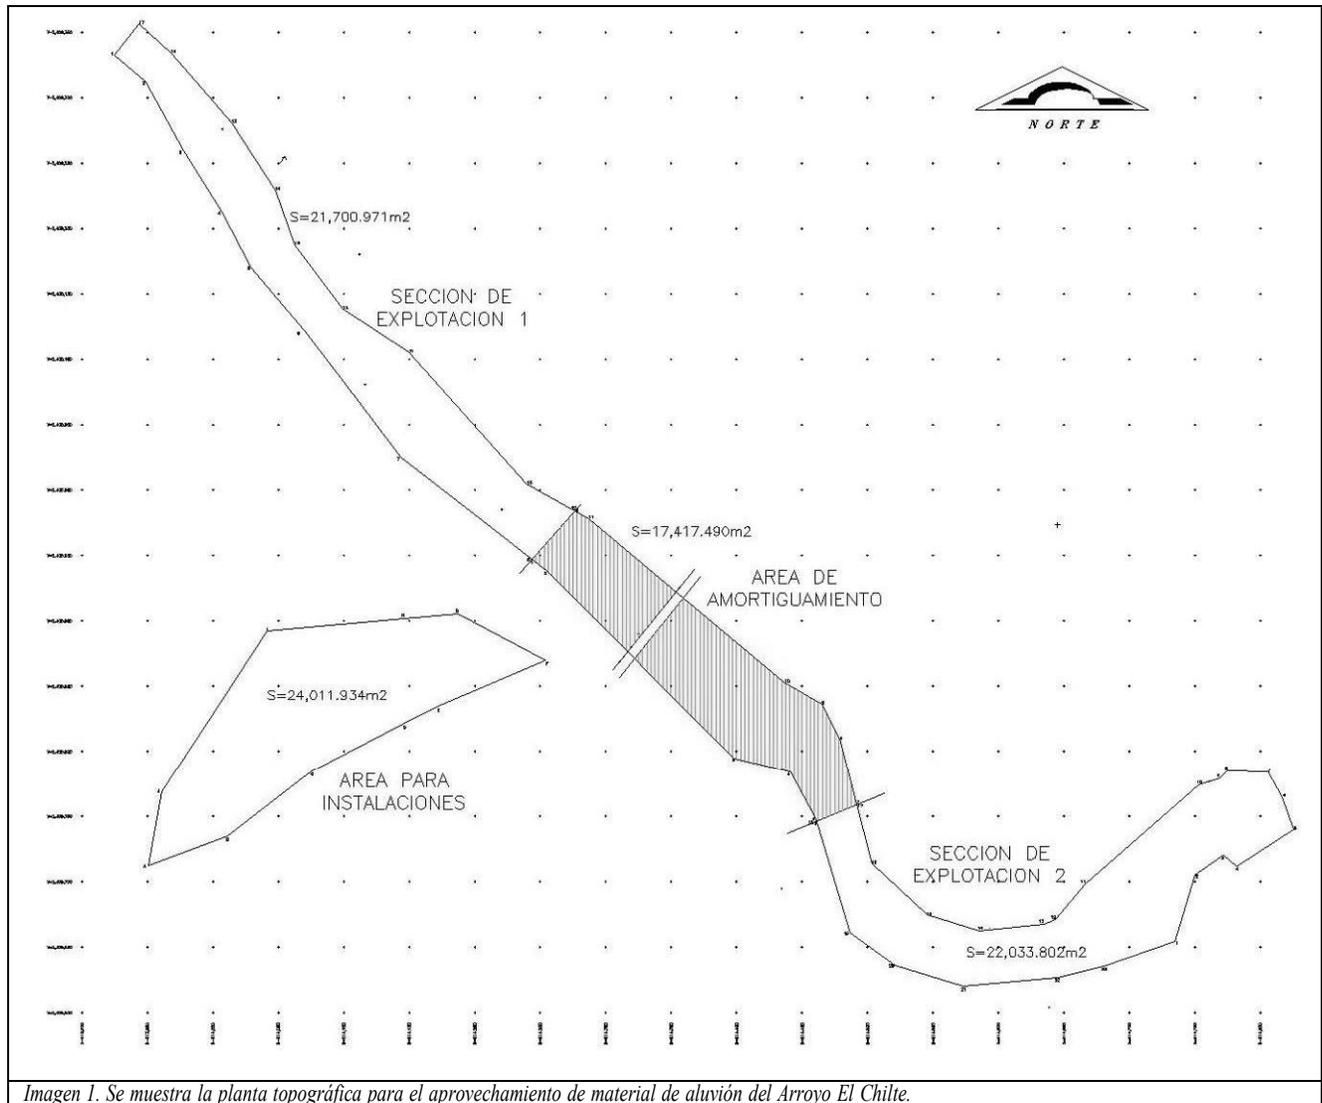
Se muestra la planta topográfica para el aprovechamiento de material de aluvión del Arroyo El Chilte.
